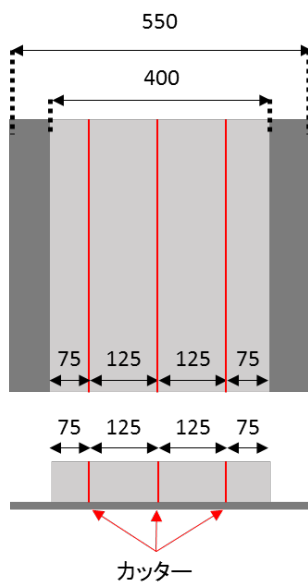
模擬貫通ひび割れ施工図
